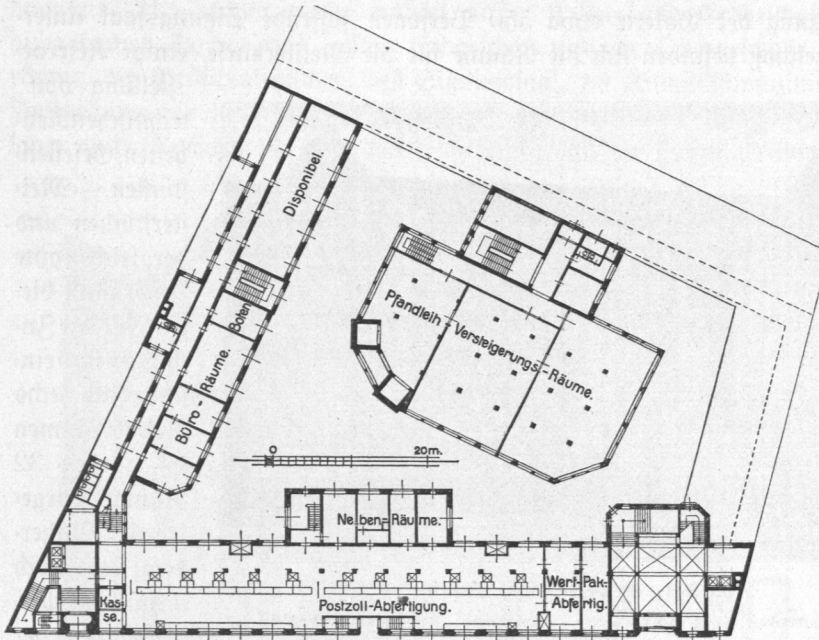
Post-Zollabfertigungsstelle, Erdgeschloß, Grundriß.
